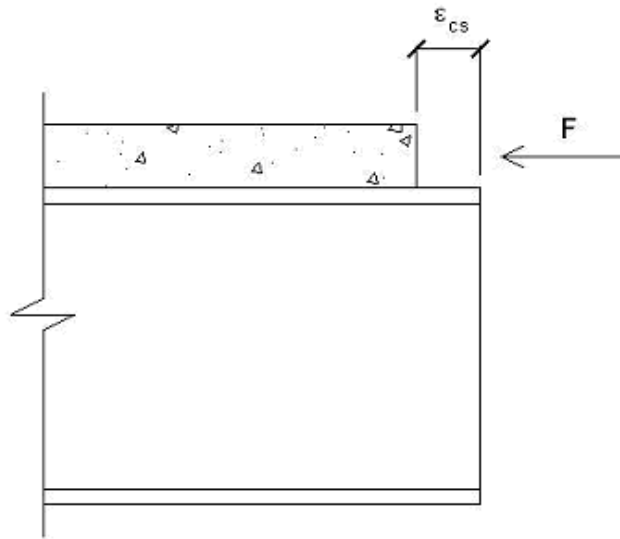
Vista longitudinal da viga mista. Encurtamento específico do concreto devido à retração.
